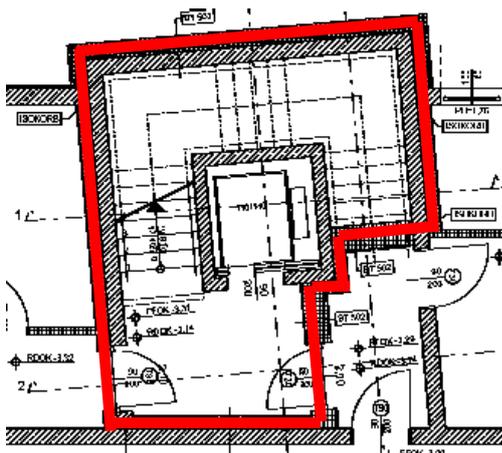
Stiegenhaus warme Hülle Grundriss [Schöberl & Pöll OEG], Vorlage [Arch. DI Franz Kuzmich]
